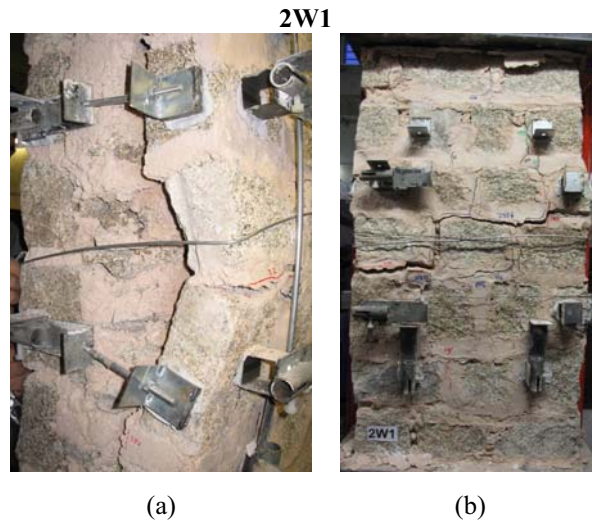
Padrão de fendilhação da parede 2W1 no final do ensaio: (a) face C; (b) face D.
